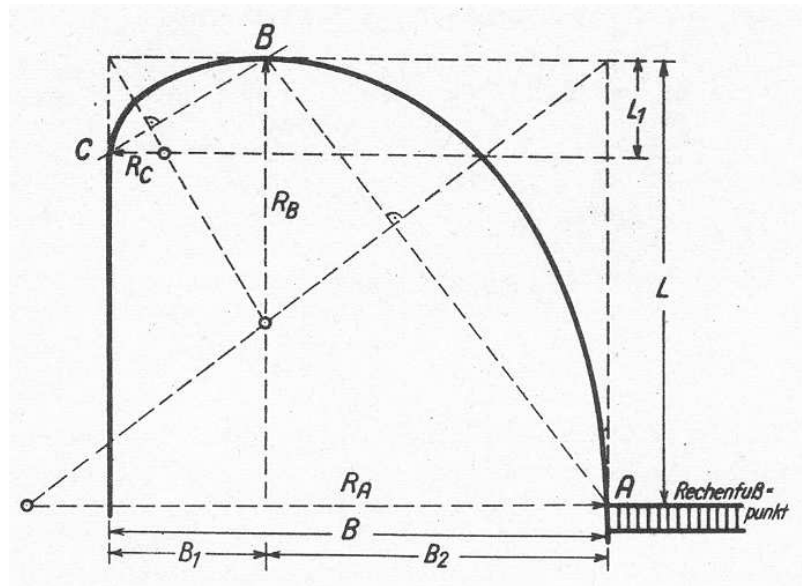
Grundriss des Trennpfeilers nach ROUVÉ (1958)
